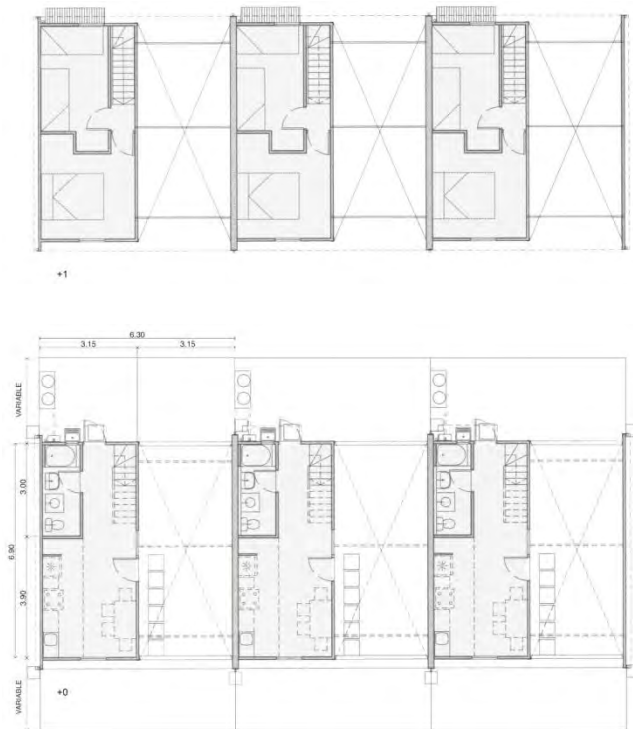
Planta baja y planta primera de las casas iniciales (43 m²) con *slack space* de Villa Verde, 2010-2013
